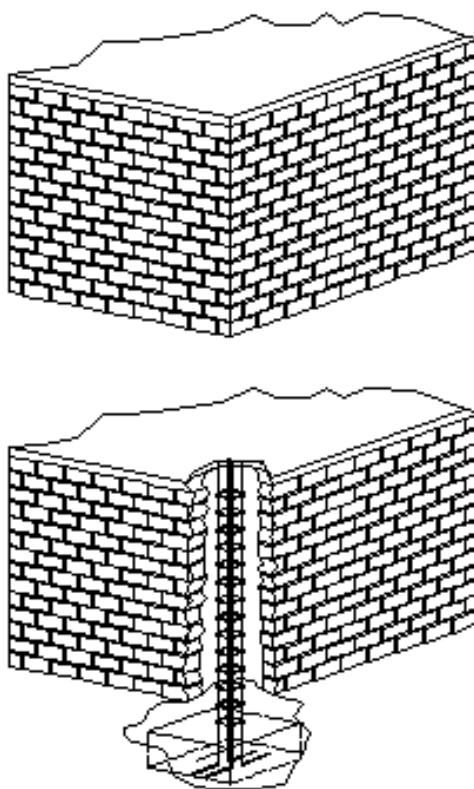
Detalle de inclusión de columnas de reforzamiento en muro sin confinamiento existente
